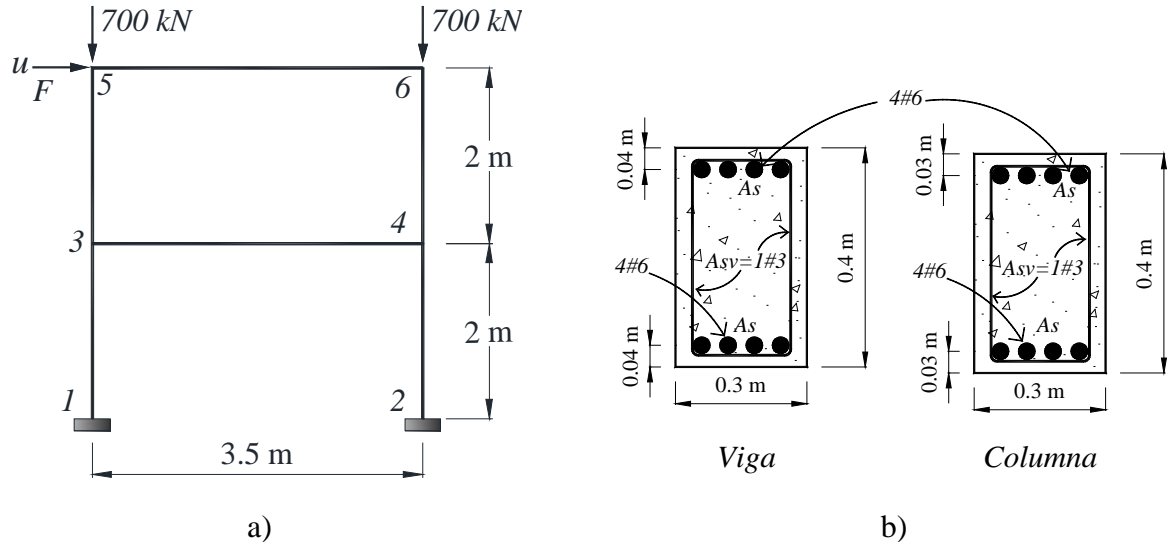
a) marco estructural y b) detalle de las secciones transversales
